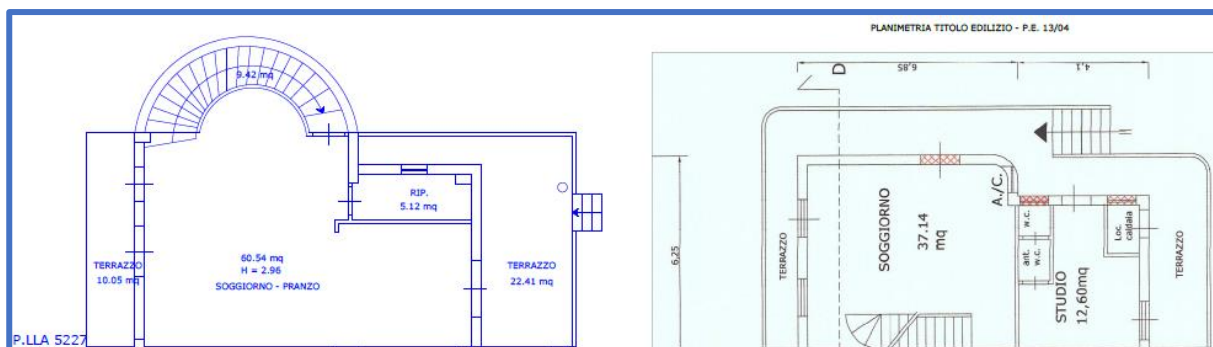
Fog. 175 P.la 5227 sub 1 – sub 2 Piano Terra – Sovrapposizione P.E. 13/2004
